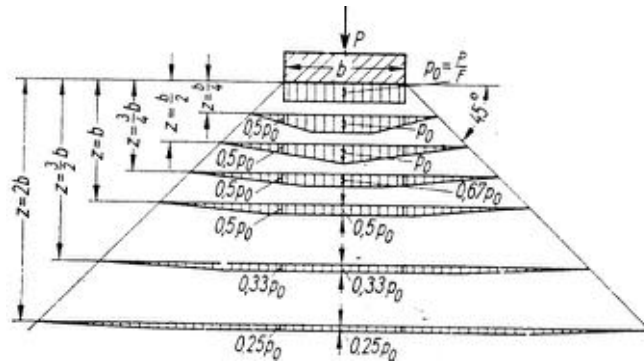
Distribución de tensiones verticales bajo una cimentación corrida
